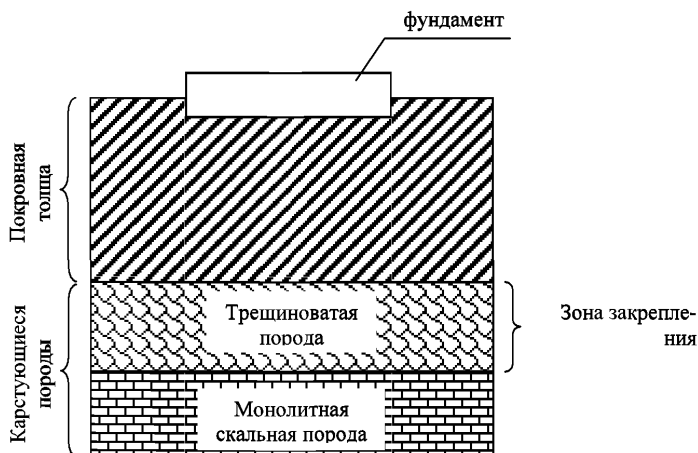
Закрепление трещиноватой толщи карстующихся грунтов до кровли монолитной породы
